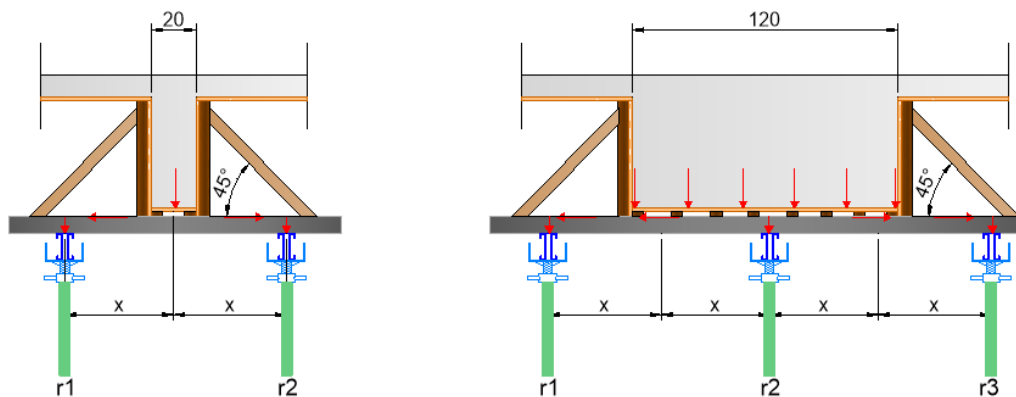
Corte de viga - carga concentrada e carga distribuída
